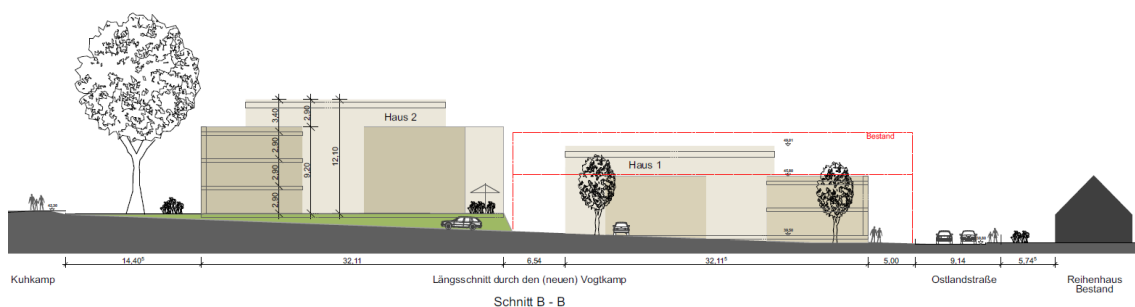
Schnitt B-B als Längsschnitt durch den (neuen) Voigtkamp
